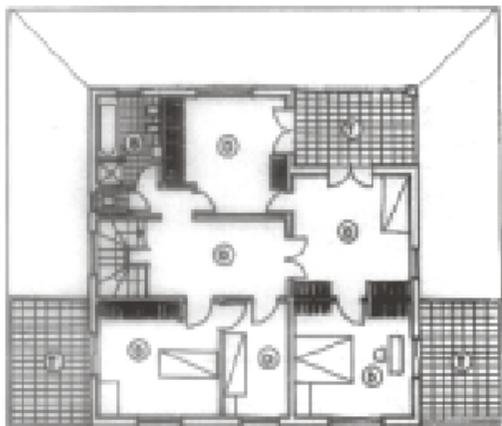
Gregori Warchavchic , Casa do Arquiteto, Planta baixa do pavimento superior, 1927 – 1928, São Paulo.
